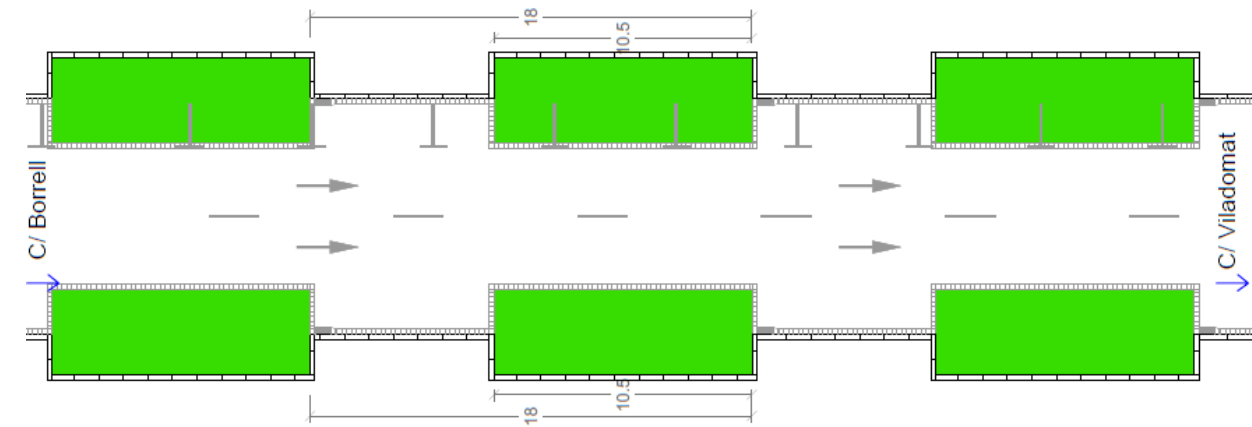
Planta de la propuesta para la C/ Mallorca, caso c) (Tipo 2).
